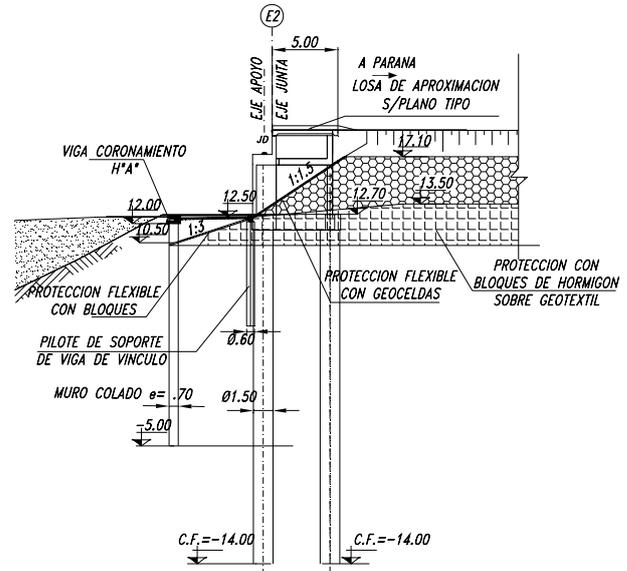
c Corte longitudinal de la solución de protección en estribo existente. Alternativa 1
